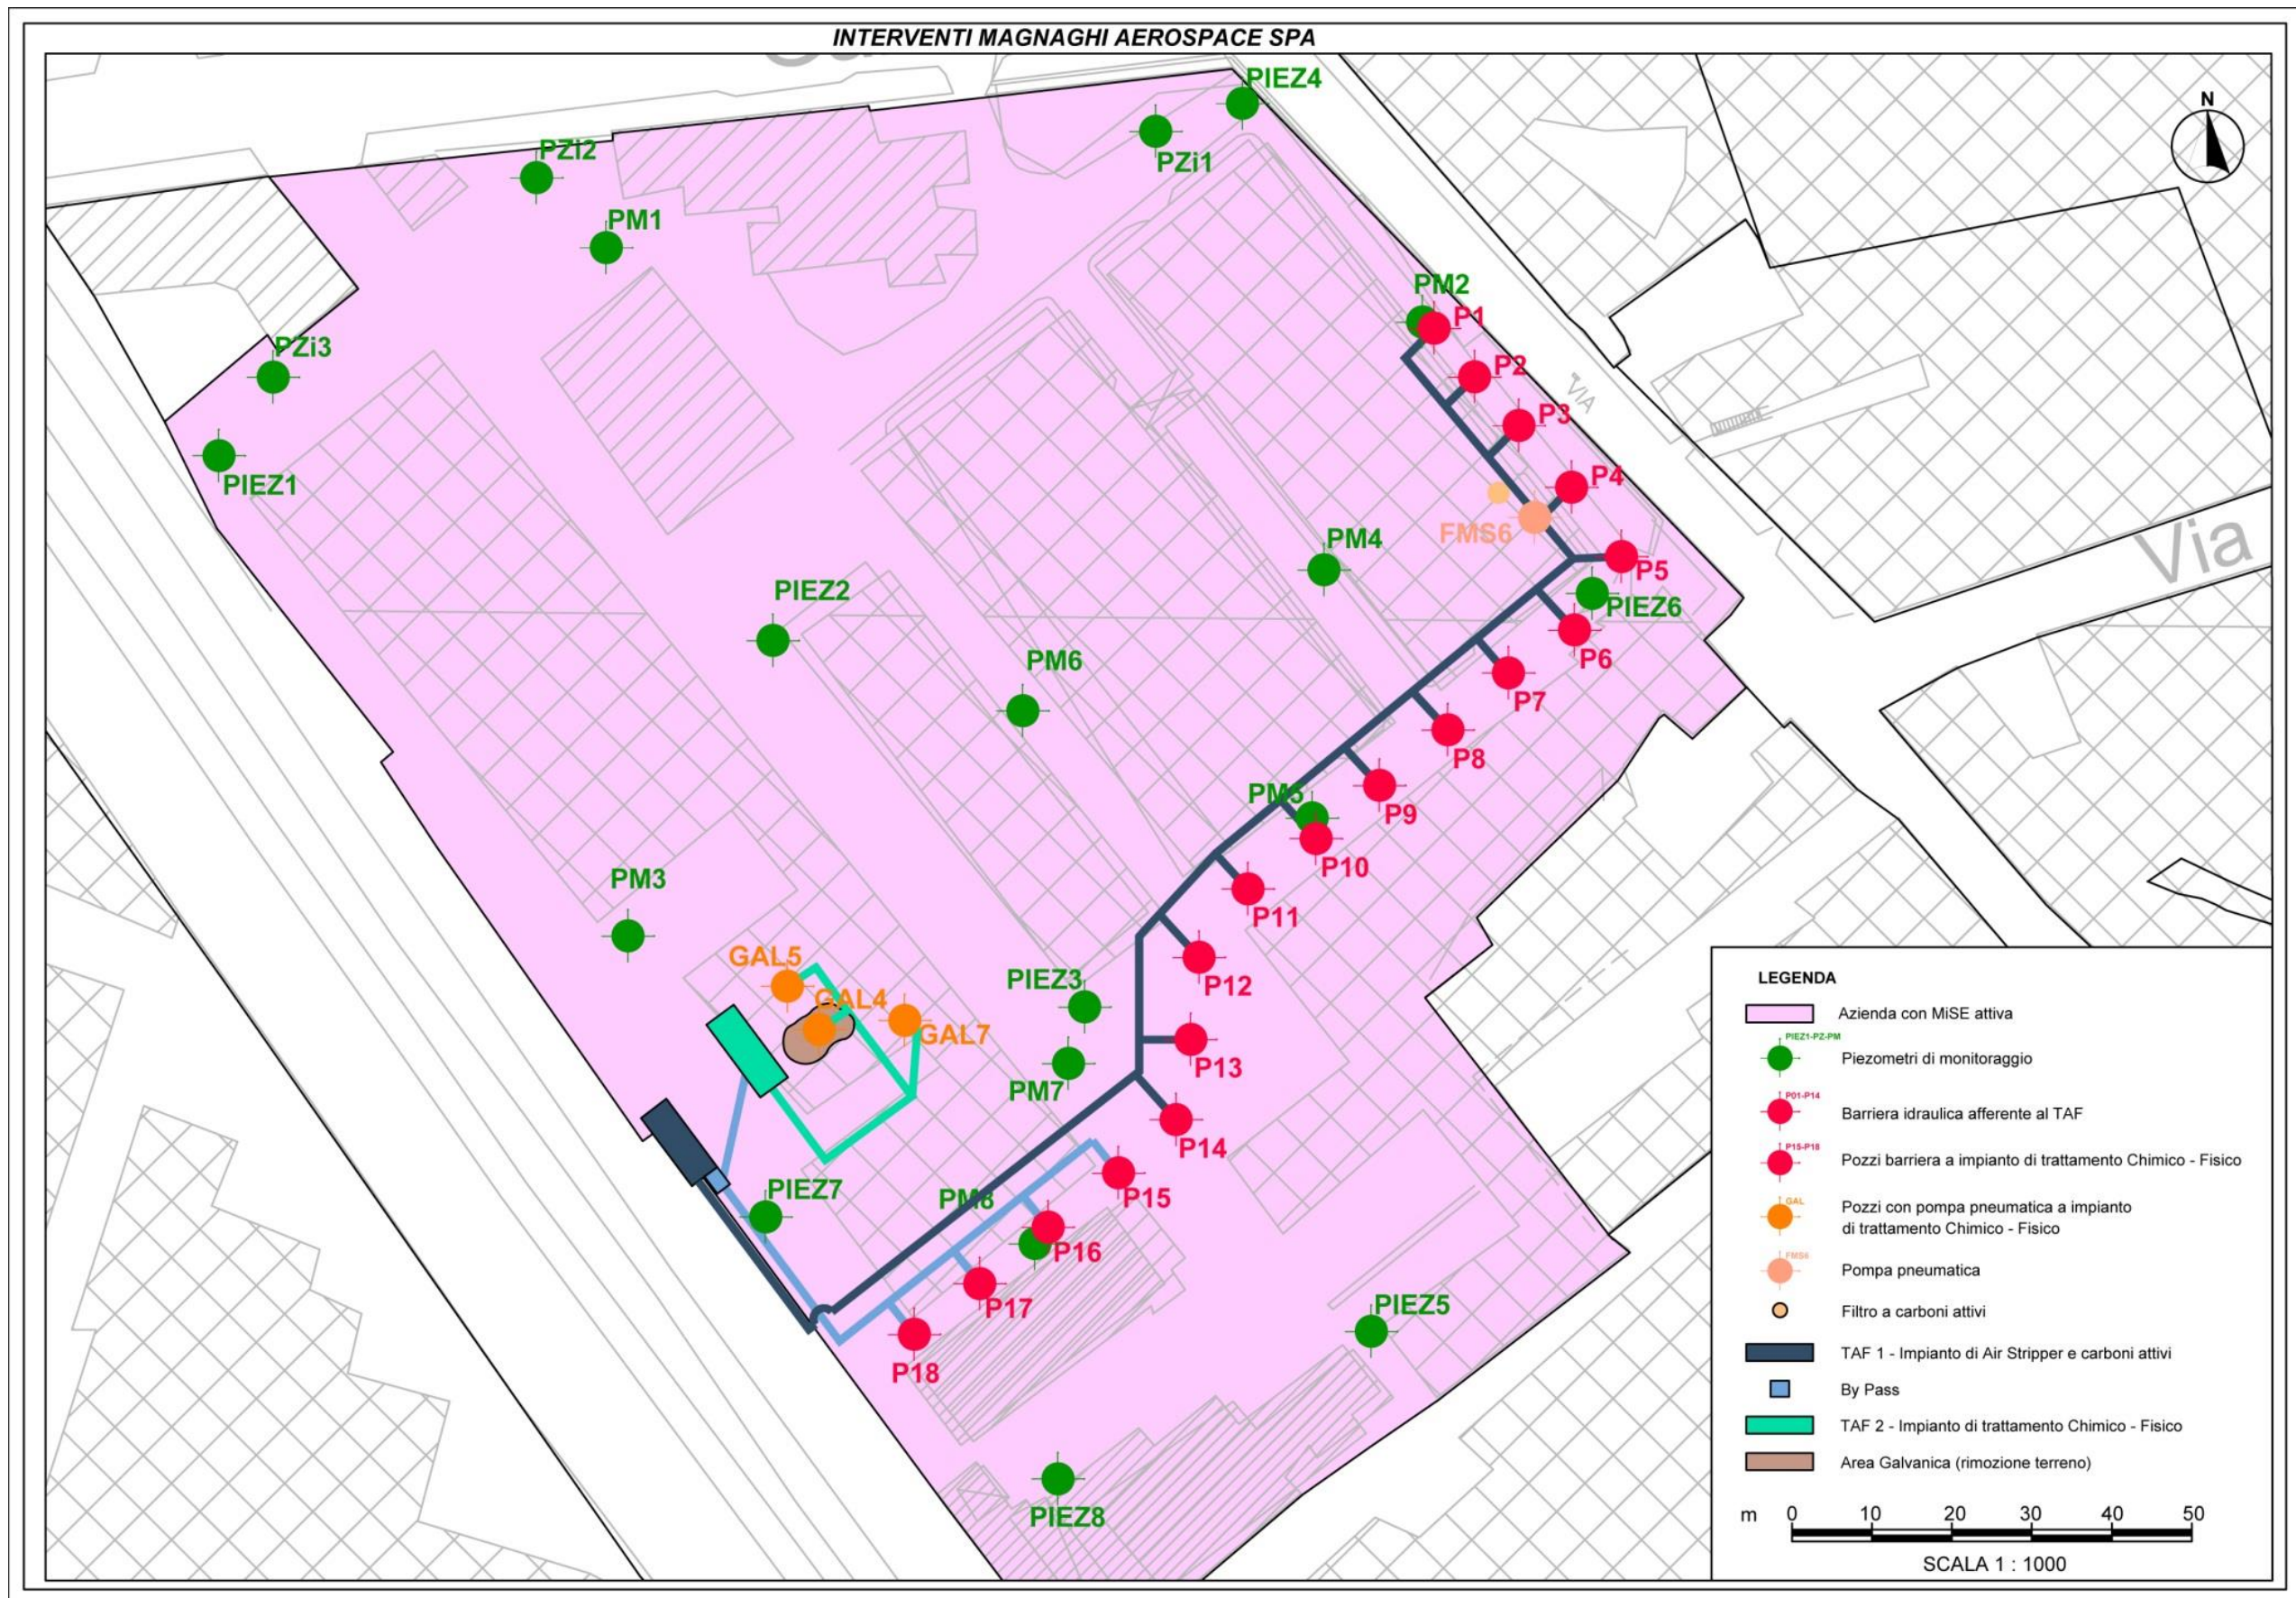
Planimetria ubicazione interventi di MISE – MAGNAGHI AEROSPACE
